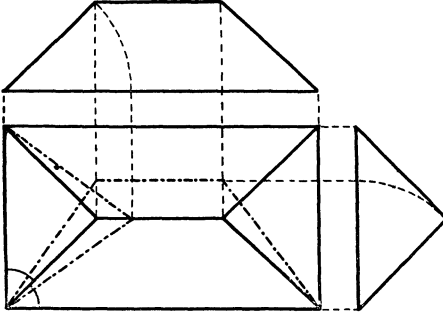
Walmdach. (Alle Dachflächen haben gleiche Neigung).
